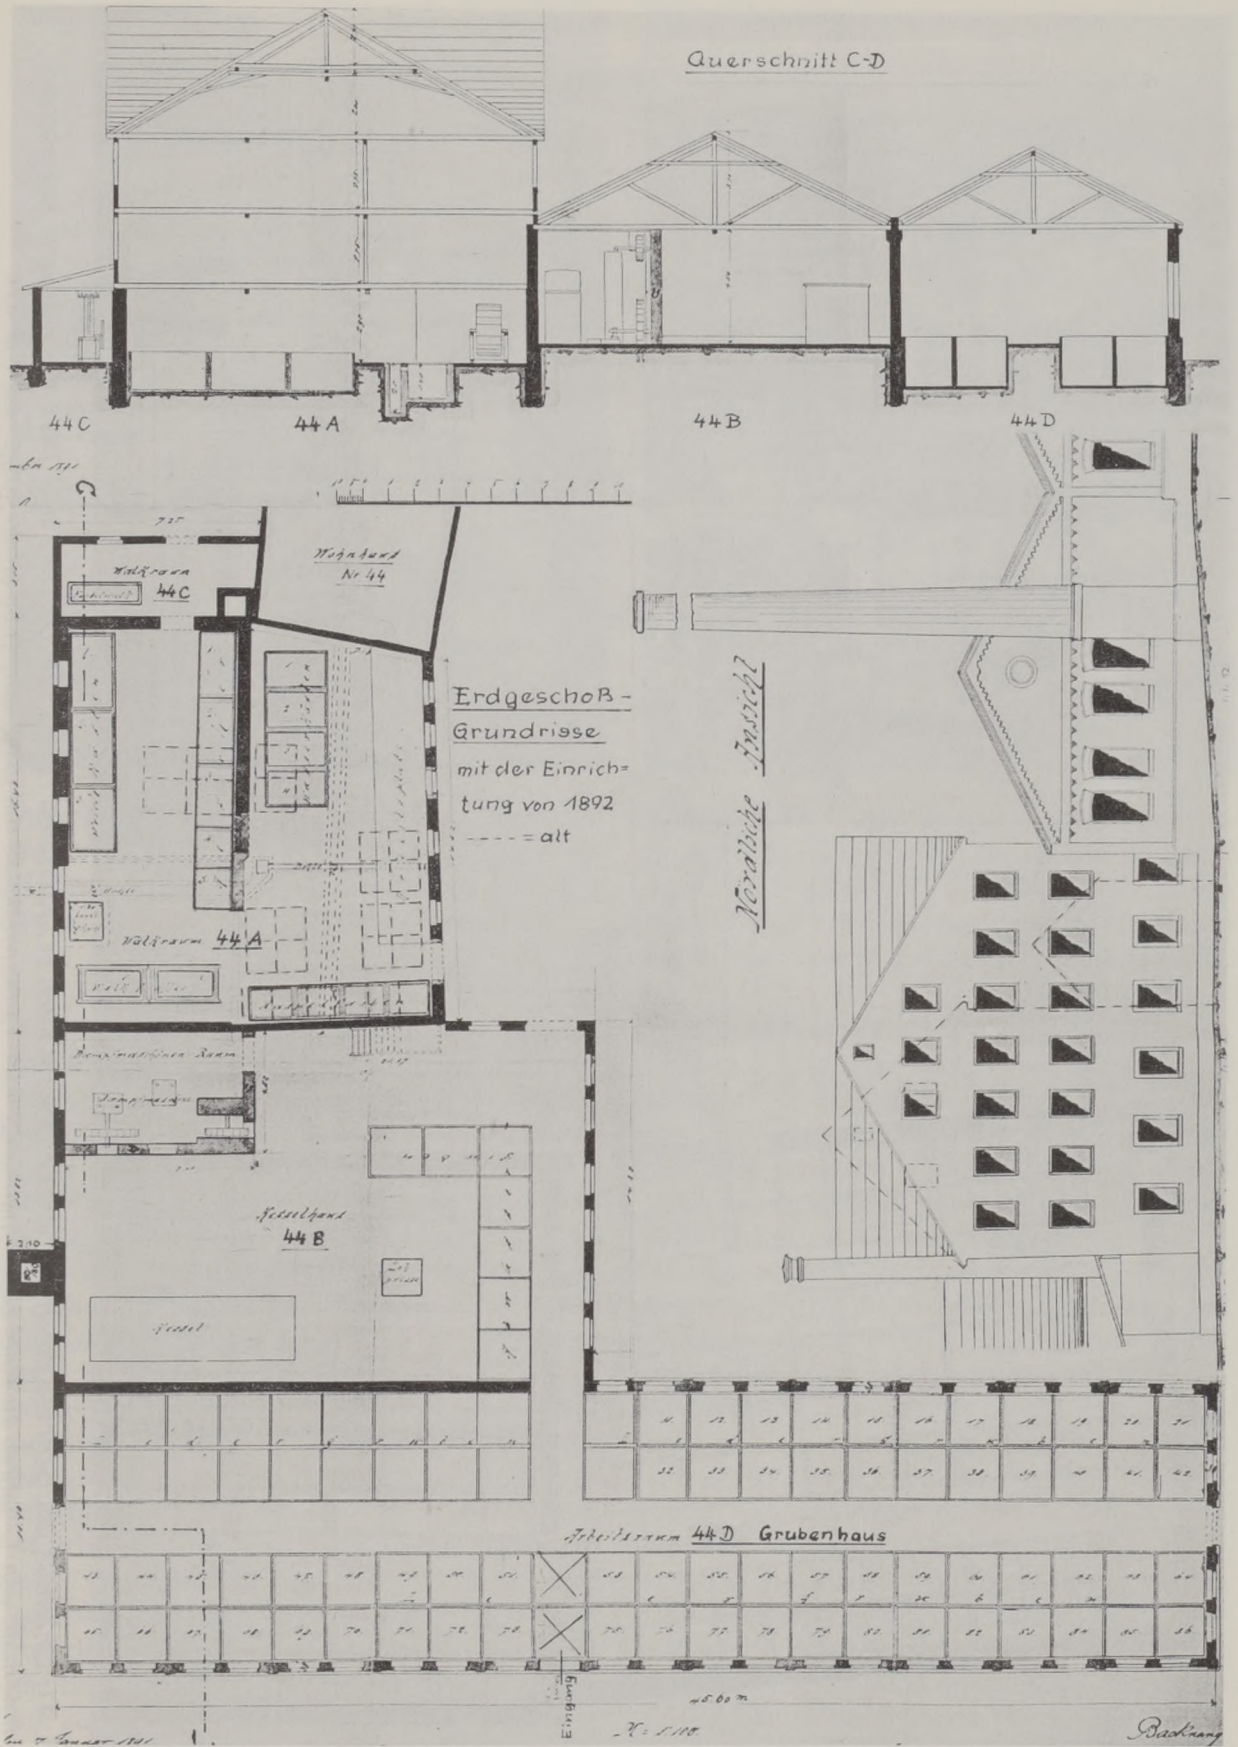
Grundriss der Gebäude 44 A bis D mit dem Stand der Einrichtungen vom Jahr 1892 sowie einem Teil der Ansicht Murrseite und dem Schnitt durch die Gebäude 44 A-C.
